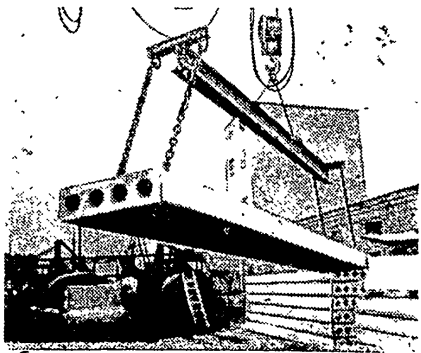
Многопустотные армосиликатные плиты перекрытия, изготовленные в тресте Лисхимпромстрой
